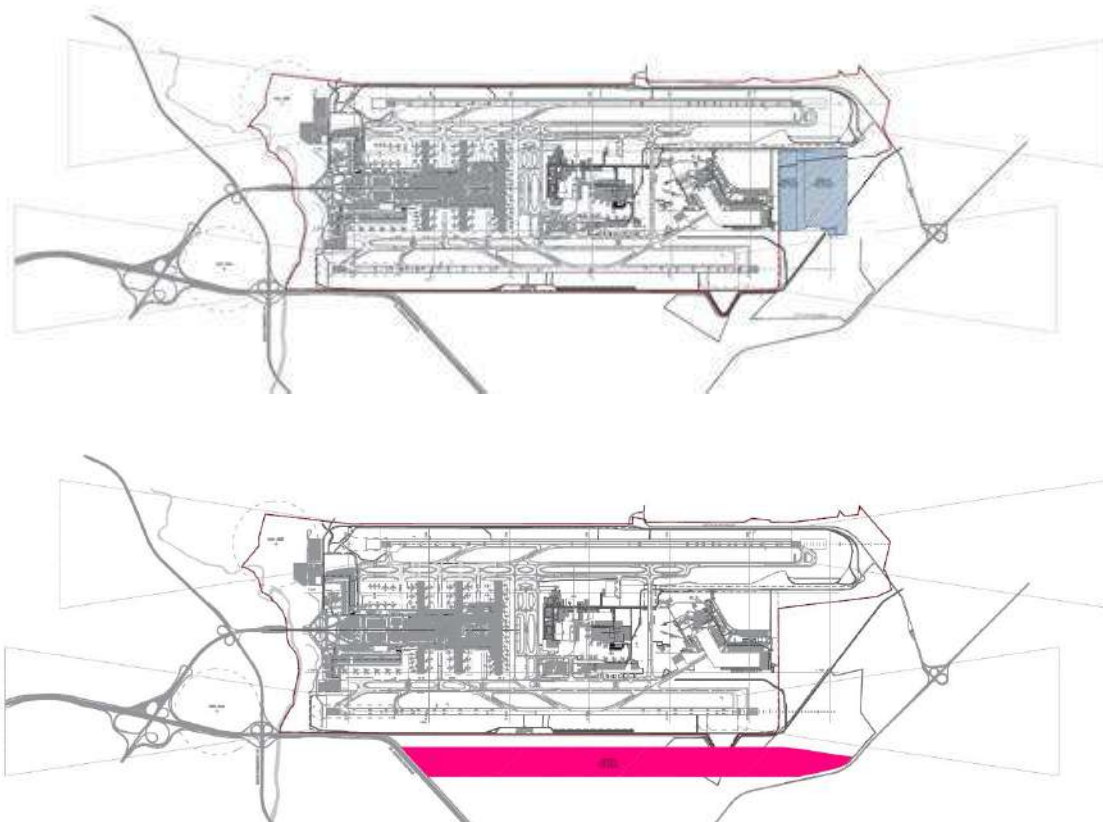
Ubicación Emplazamiento y ubicación actual BAPU FACH y terrenos de reserva para futuro crecimiento.
